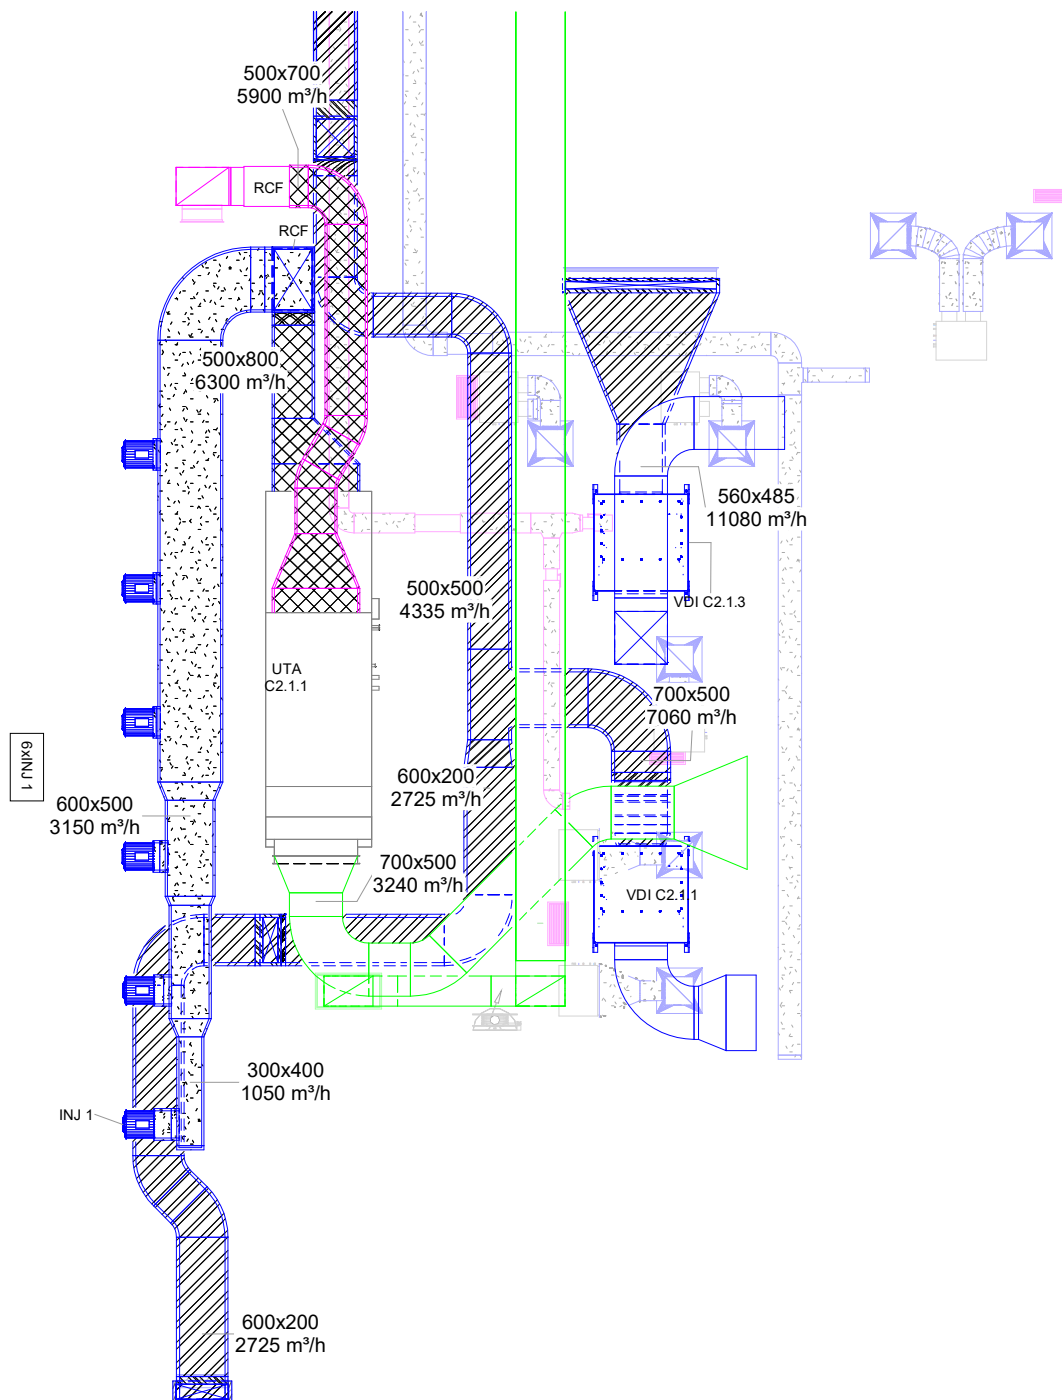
Seção 2.7 da planta geral do traçado das condutas na *mezzanine* à escala 1:100.
